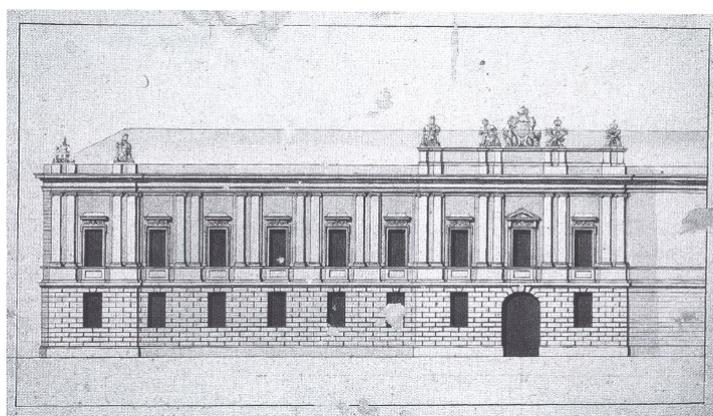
Giuseppe Piermarini, Prospetto principale del Monte di S. Teresa (1782)
